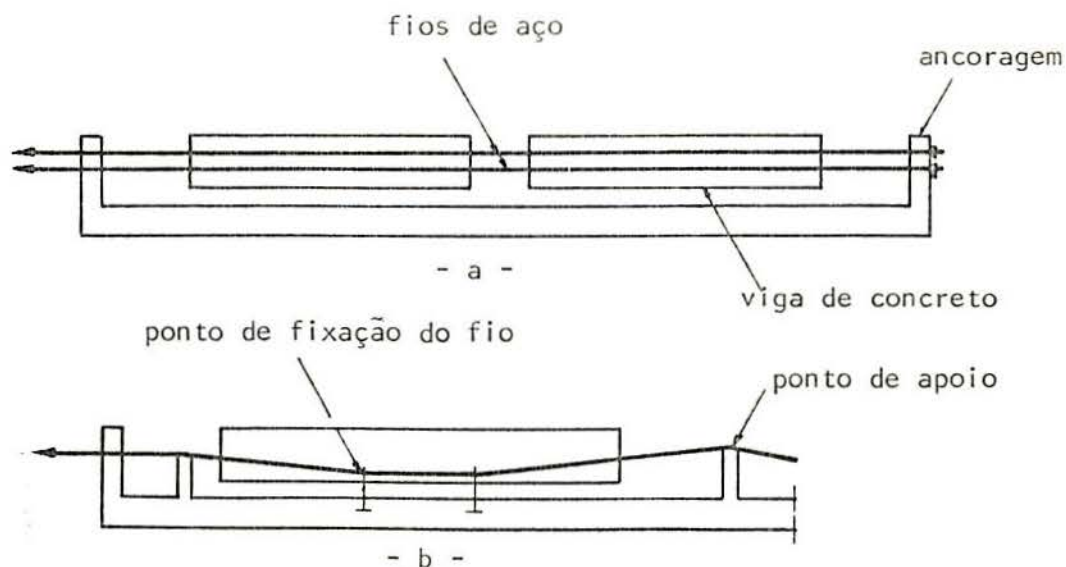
Sistema com armaduras pré-tracionadas:
